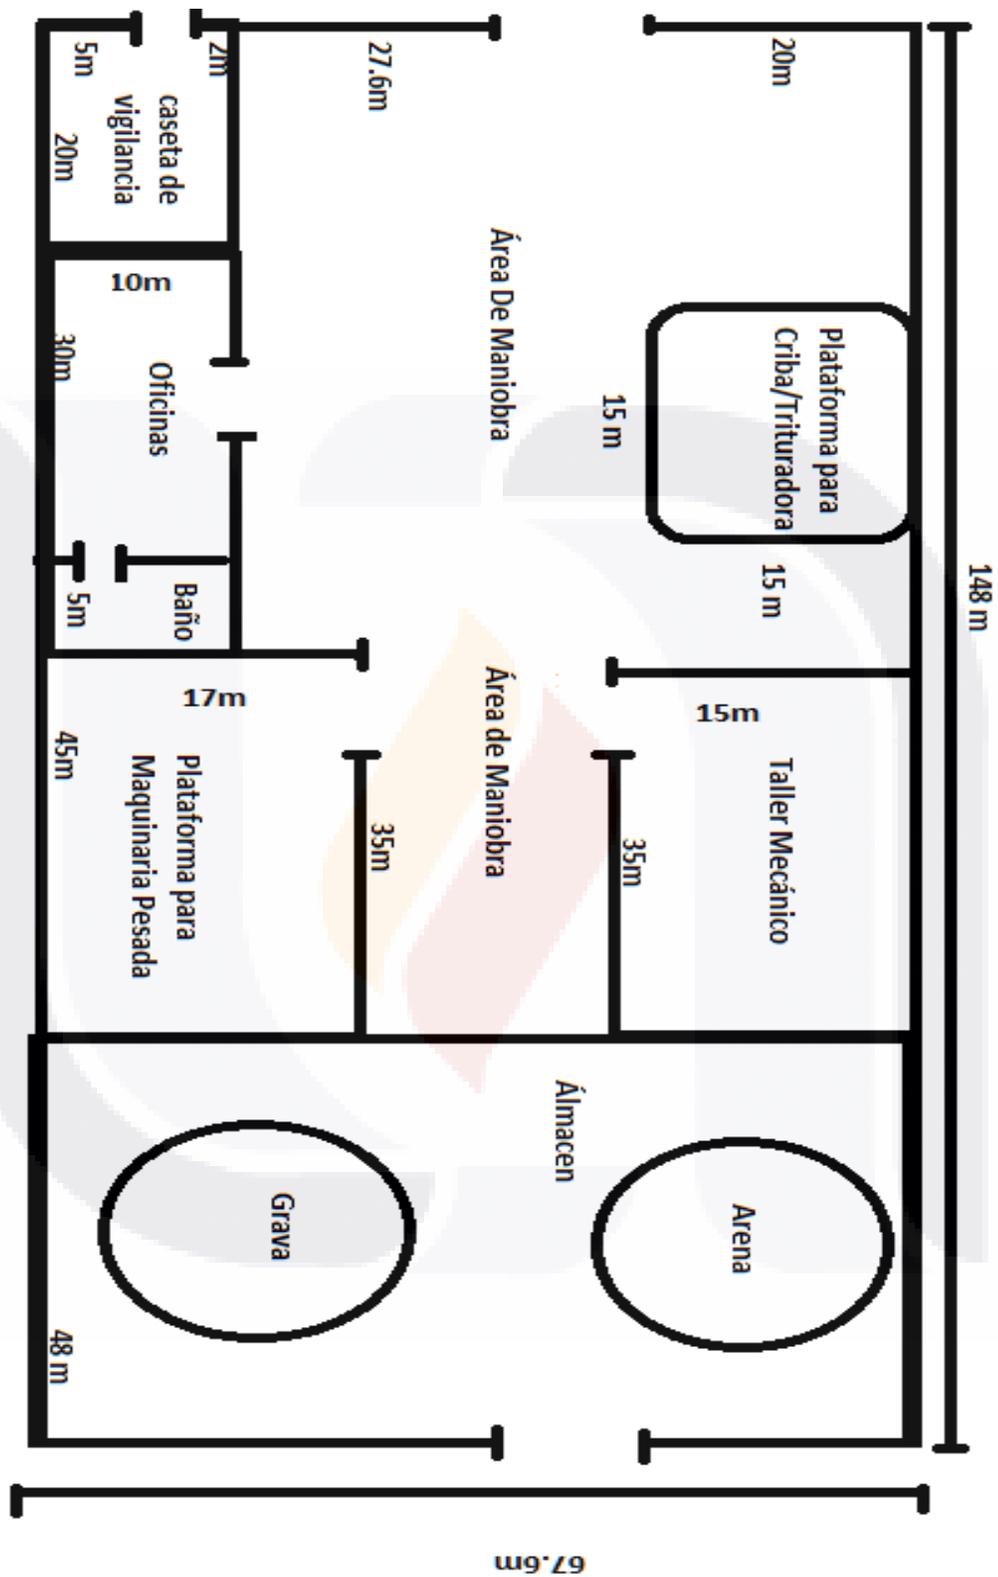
Distribución de la planta. Fuente. Elaboración propia (16 de febrero de 2014)
